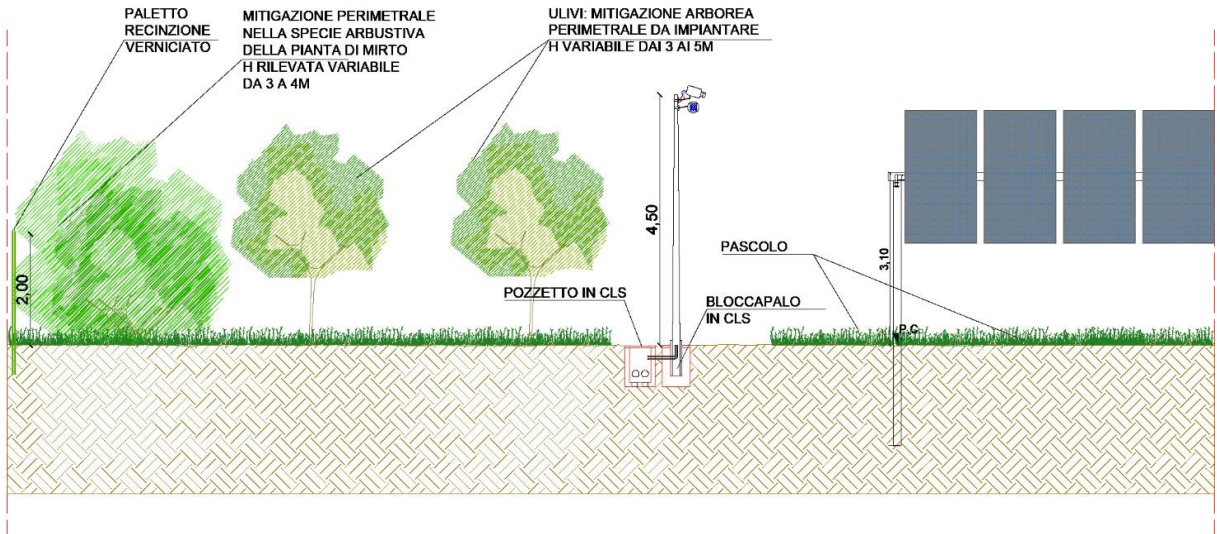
Dettaglio recinzione e mitigazione perimetrale
